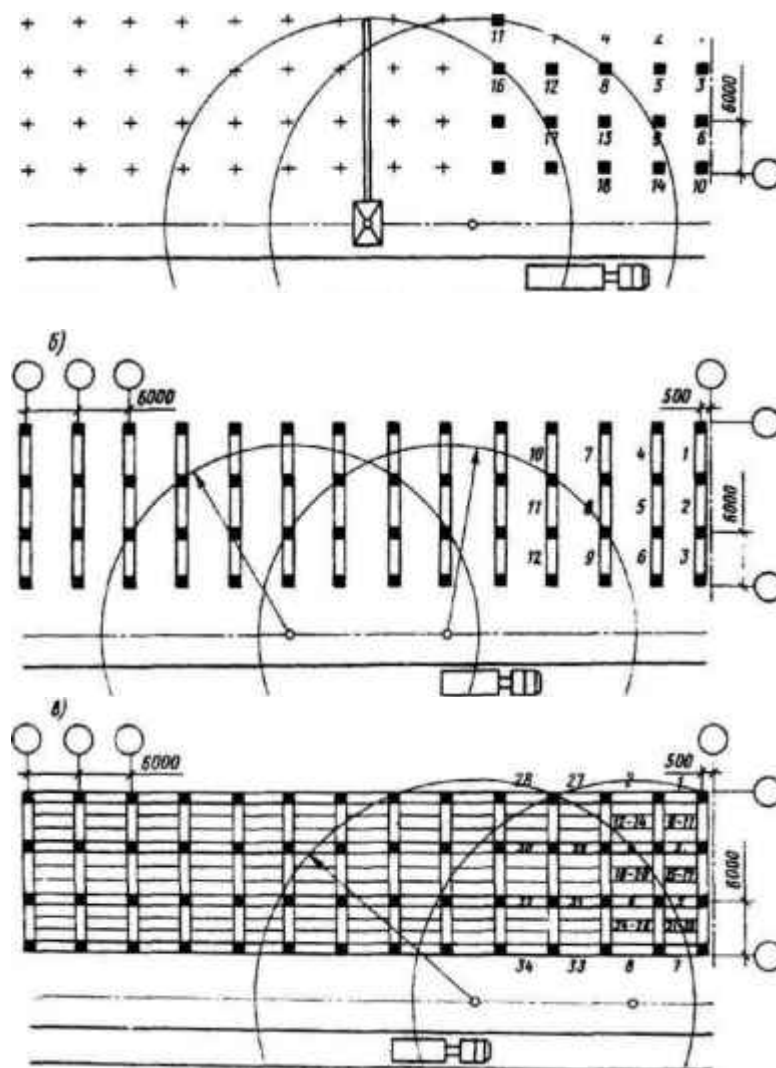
Схема монтажа бескрановых промышленных зданий башенным краном, установленным с одной стороны:
